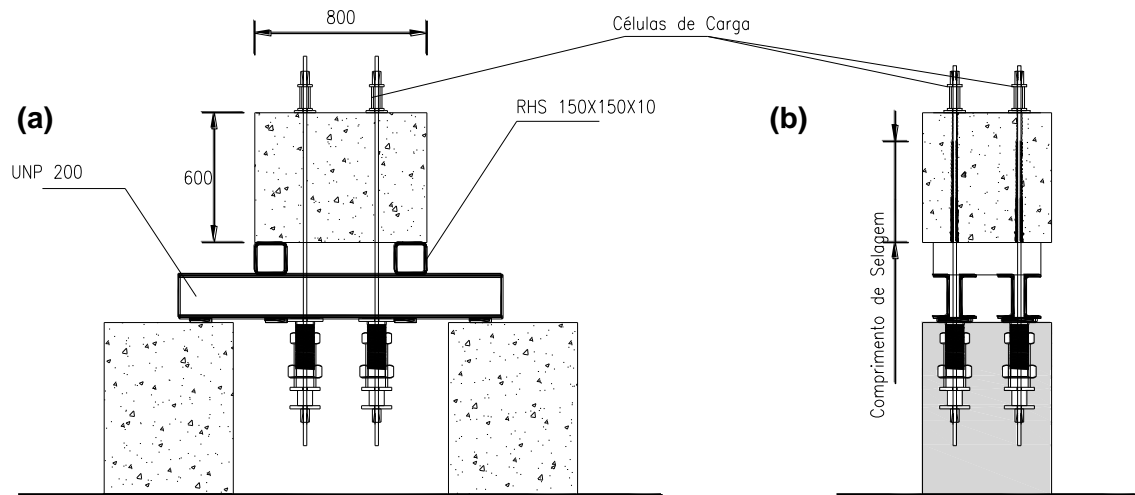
Geometria dos modelos para ensaios a longo prazo, (a) corte longitudinal e (b) corte transversal. (desenho sem escala e dimensões em mm)
